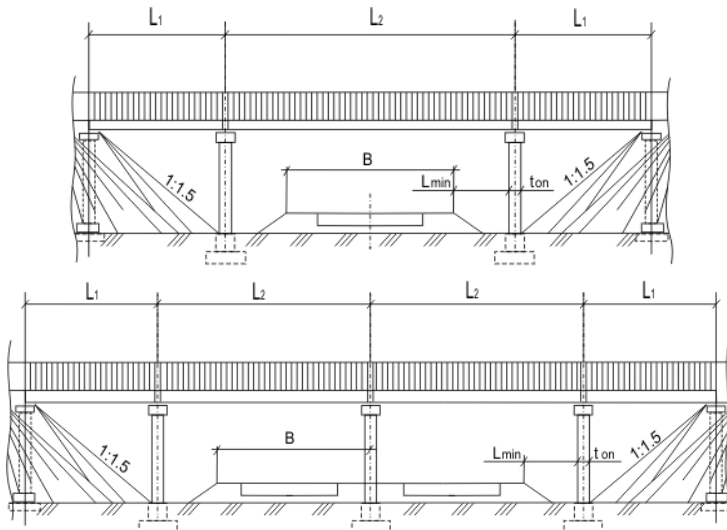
Схема балочных трехпролетных и четырехпролетных путепроводов
